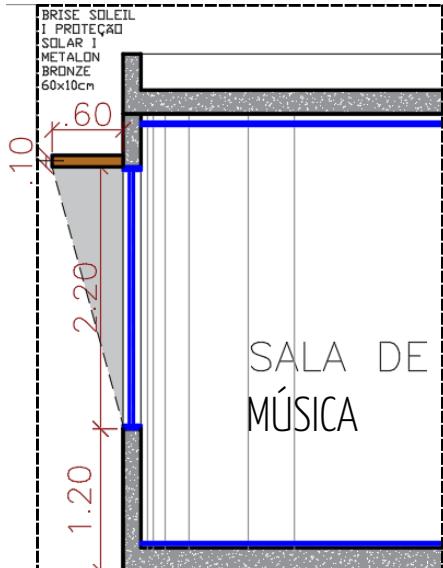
FACHADA SUL - 22 DE JUL 12H:
